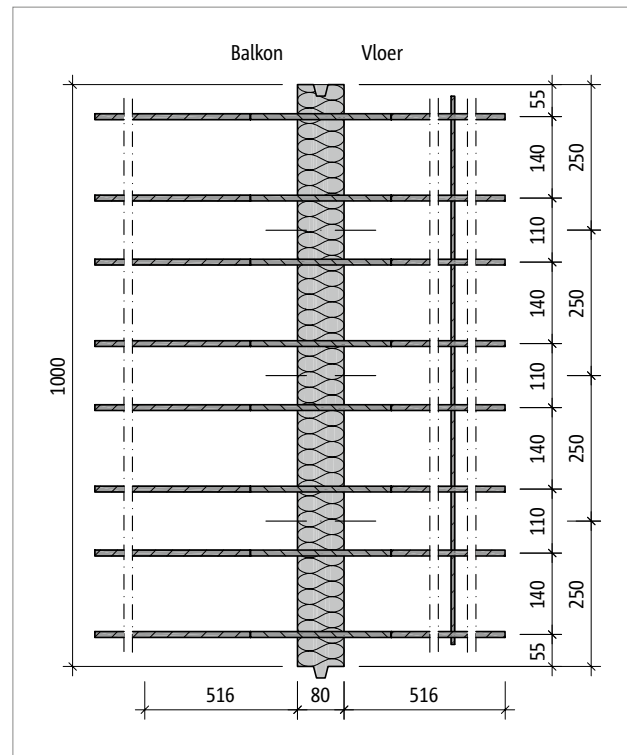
Schöck Isokorb® T type Q-E-VV5: Doorsnede
